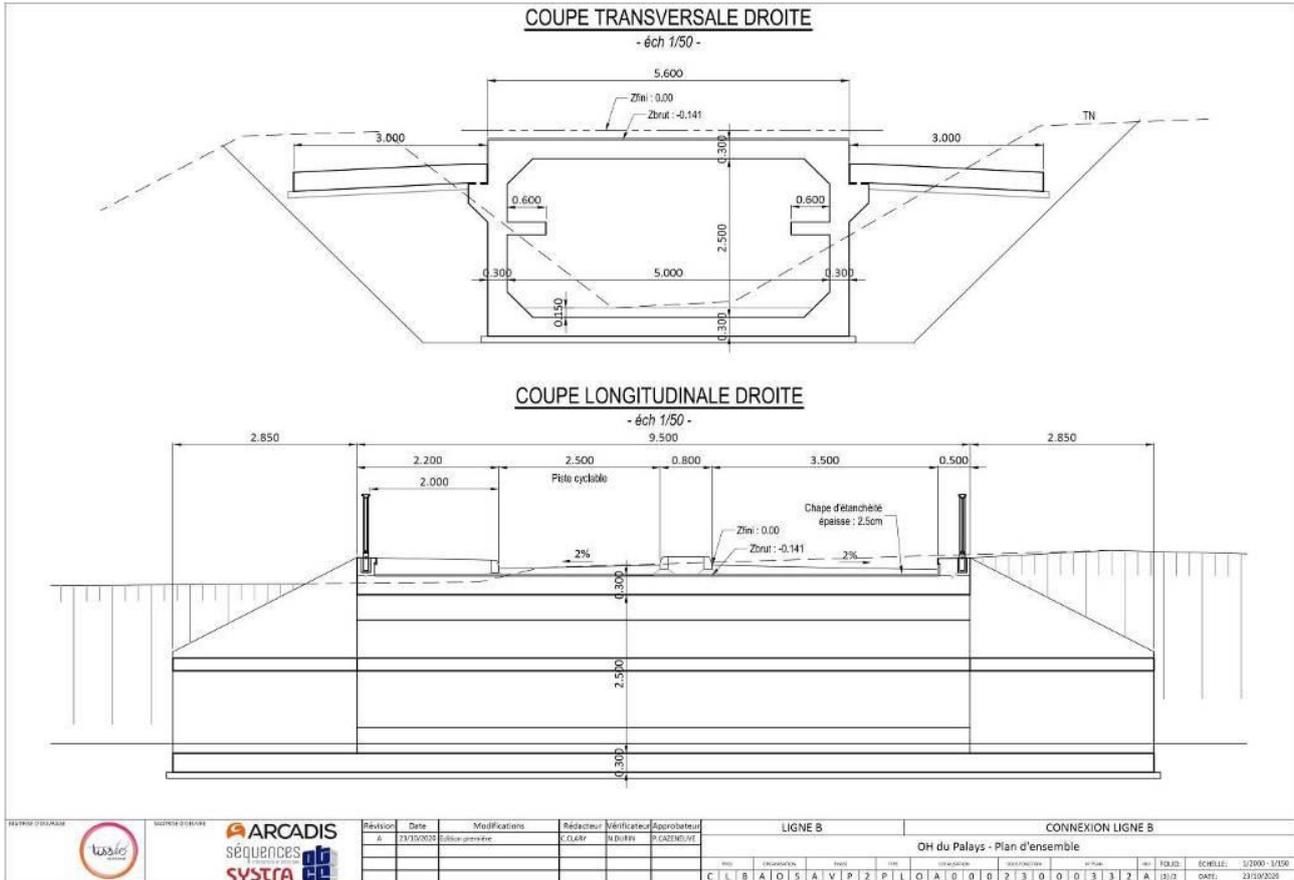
Coupe transversale droite et coupe longitudinale droite de l'ouvrage hydraulique réalisé sur le ruisseau du Palays – source DLE CLB 2021
